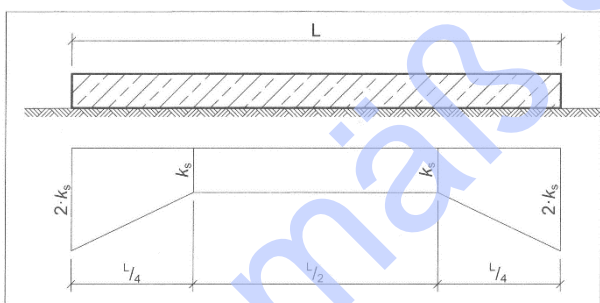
Verteilung des Bettungsmodules nach Dörken und Dehne
